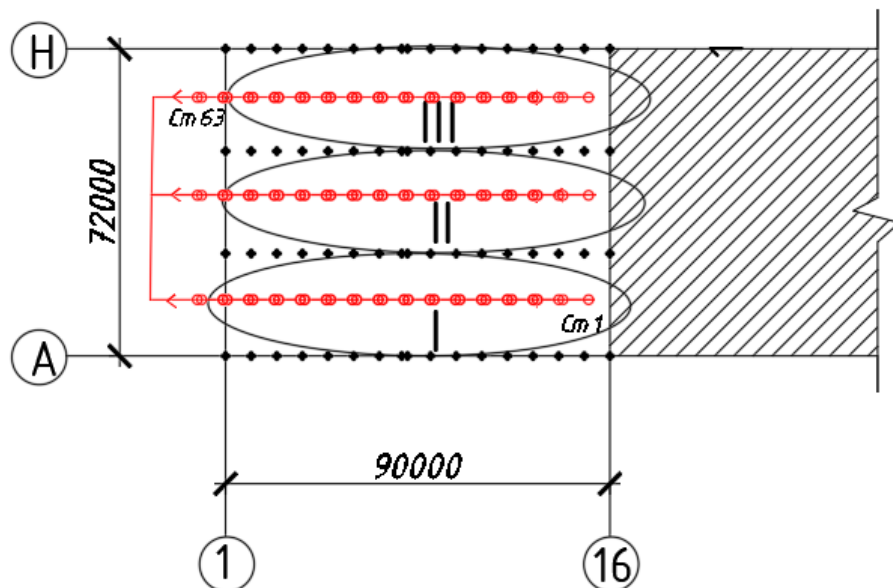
Разбивка на захваты монтажа ферм и плит покрытия промышленного здания.
